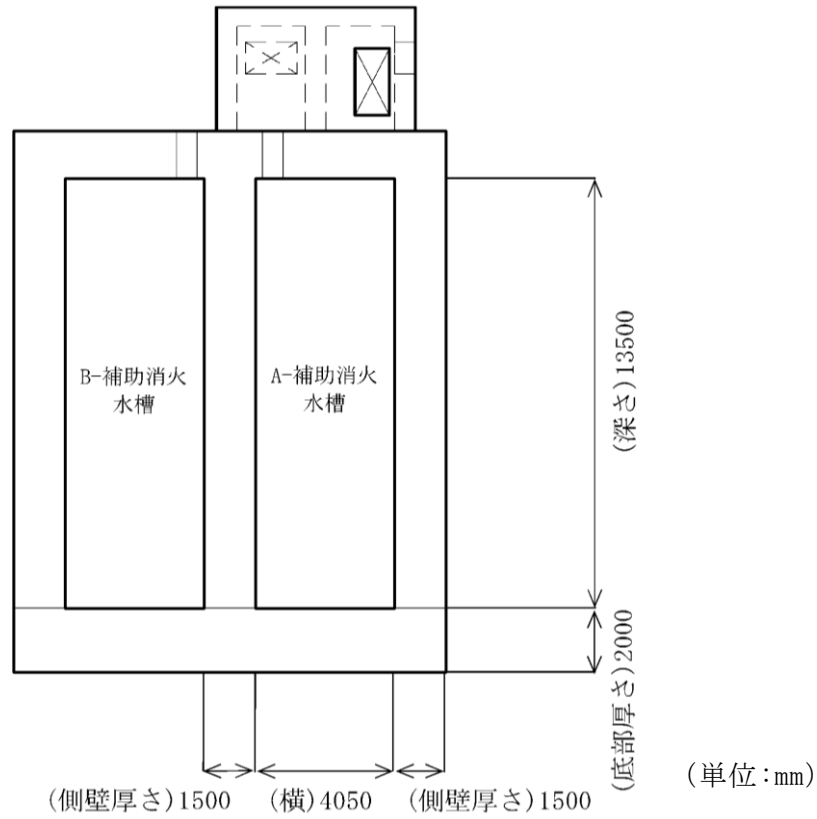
(1) 補助消火水槽 断面図 (A-A 断面)
